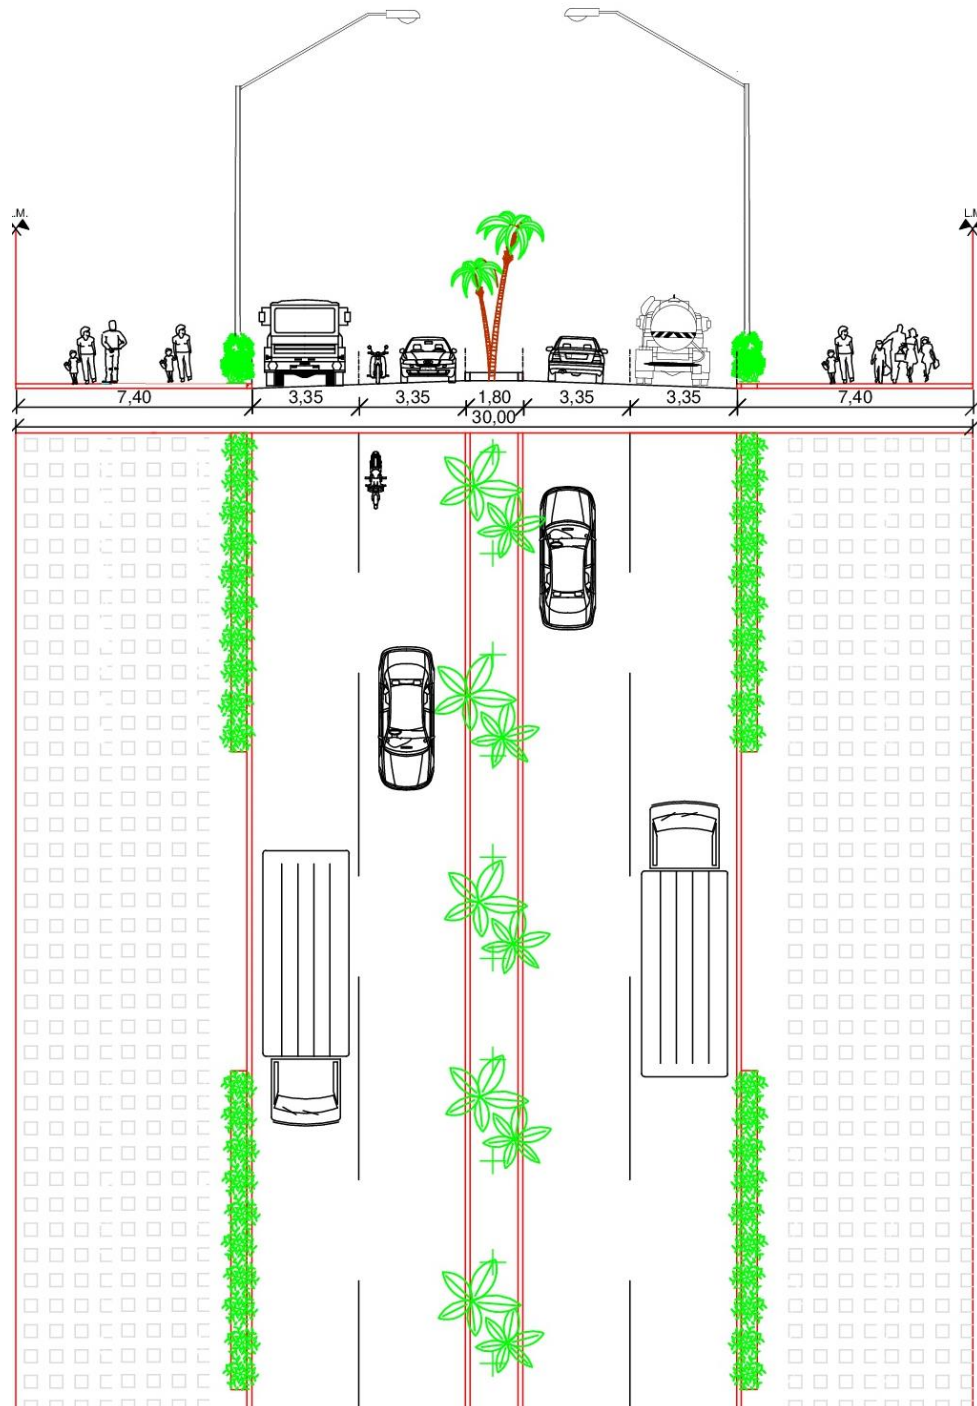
Perfil tipo para proyecto en tramo Barranqueras.
